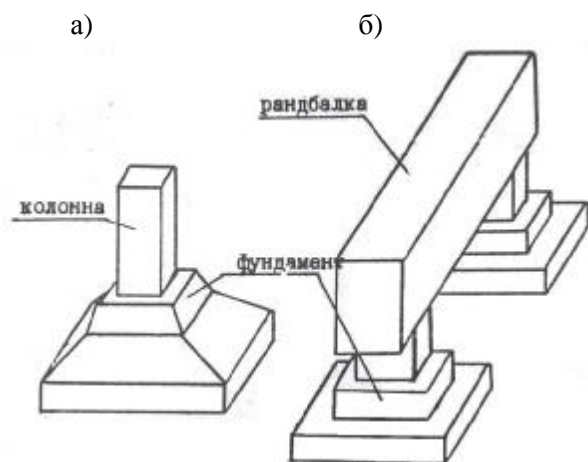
Виды столбчатых (отдельных) фундаментов:
